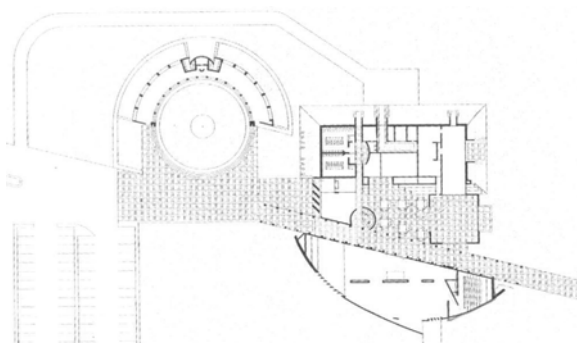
Plantas Arquitectónicas Museo de sitio Tajín.
